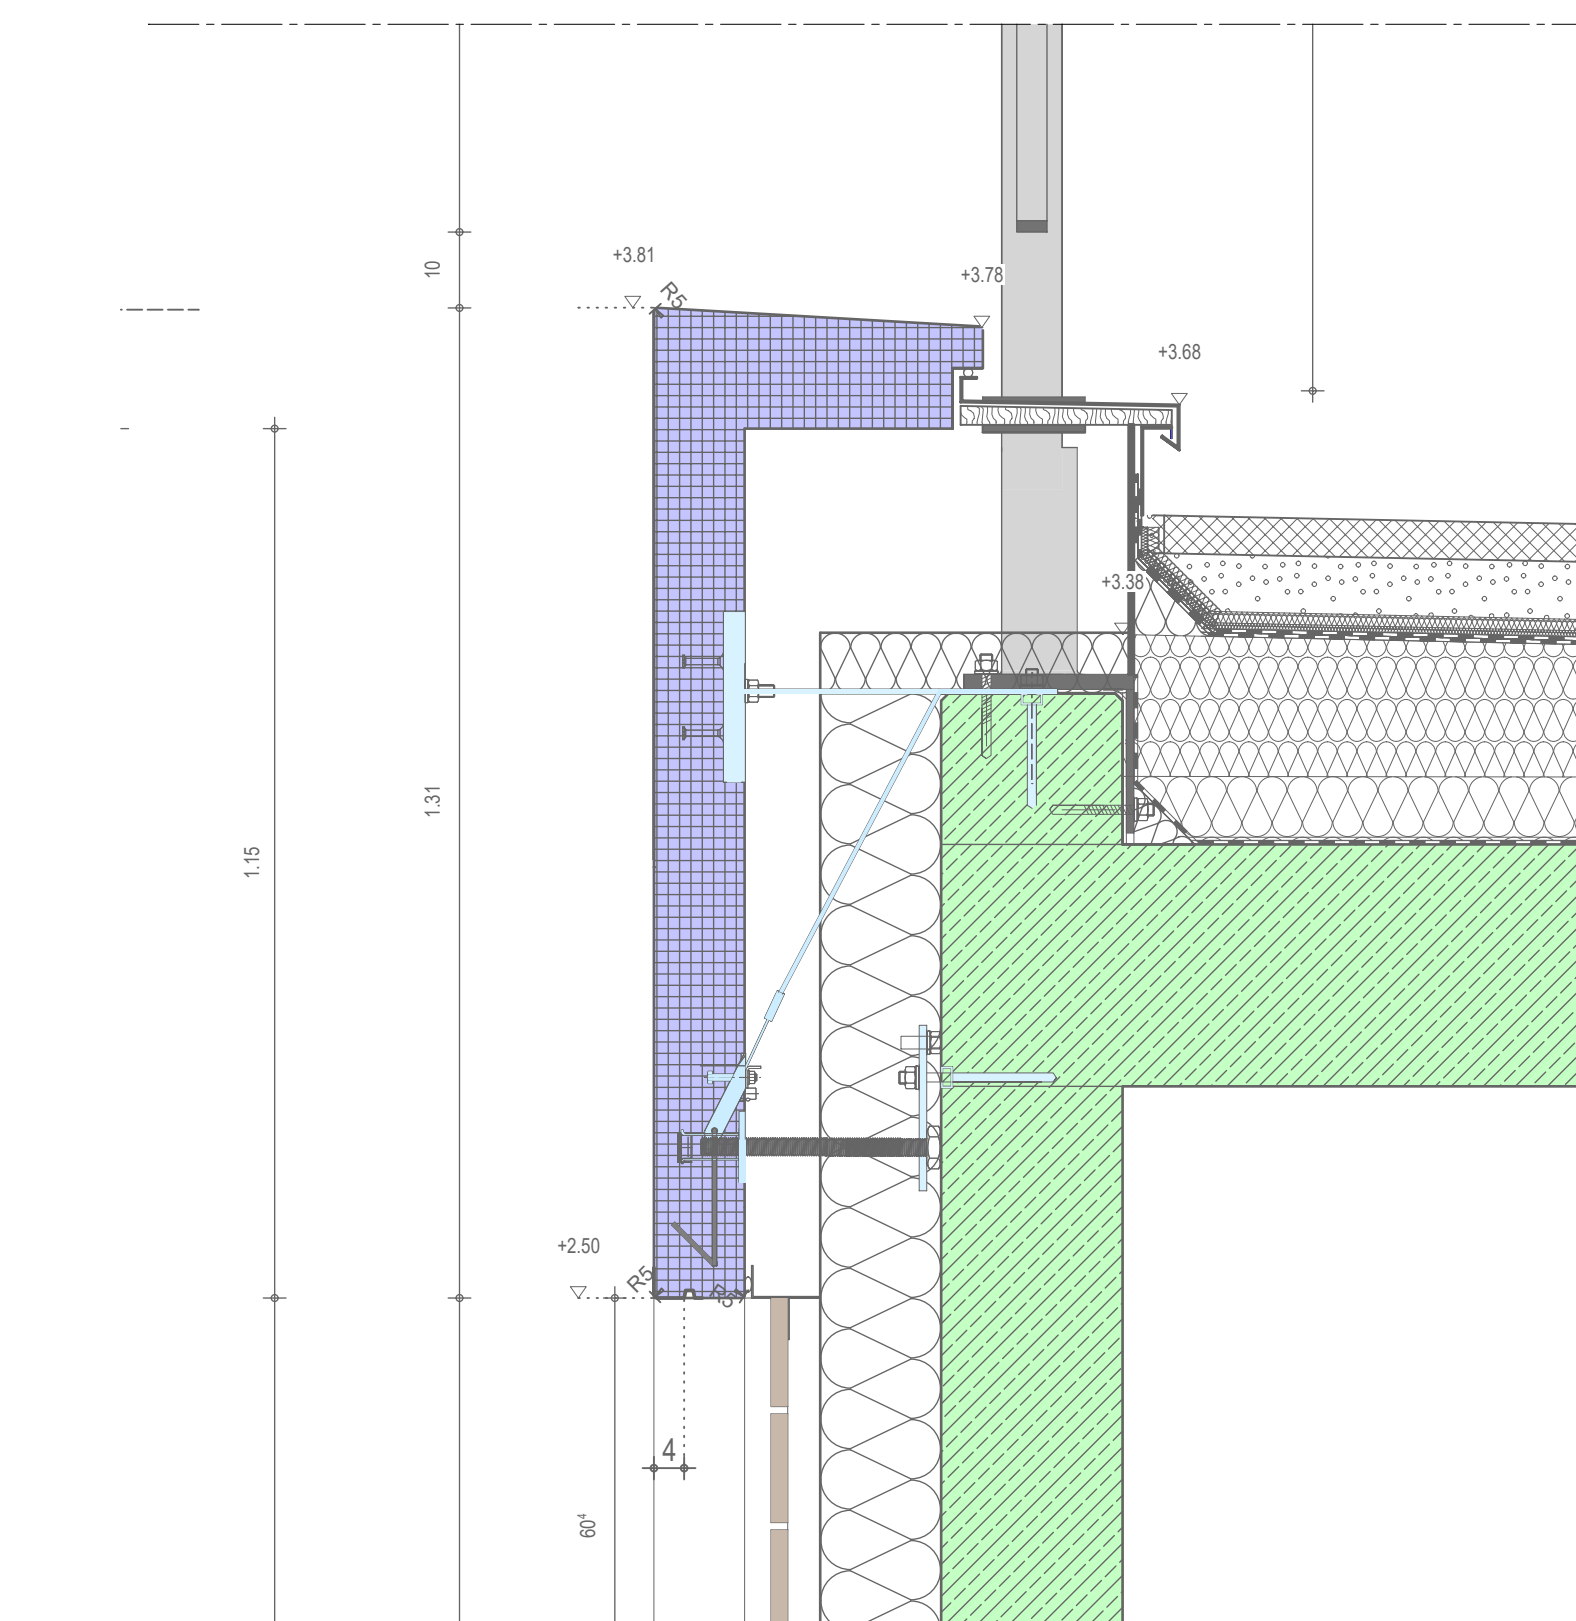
/ AUSSCHNITT GRUNDRISS EG M: 1/5
